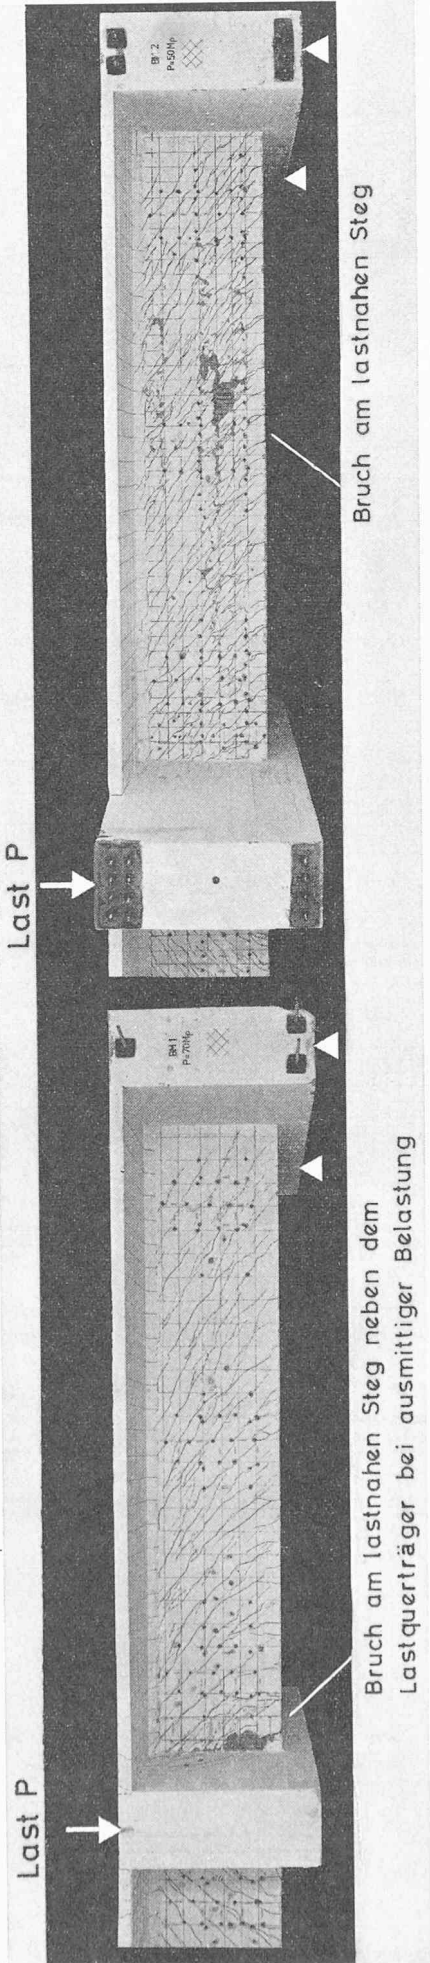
Übersicht über die Bruchlasten, Bruchursachen und Bruchstellen der beiden Träger
